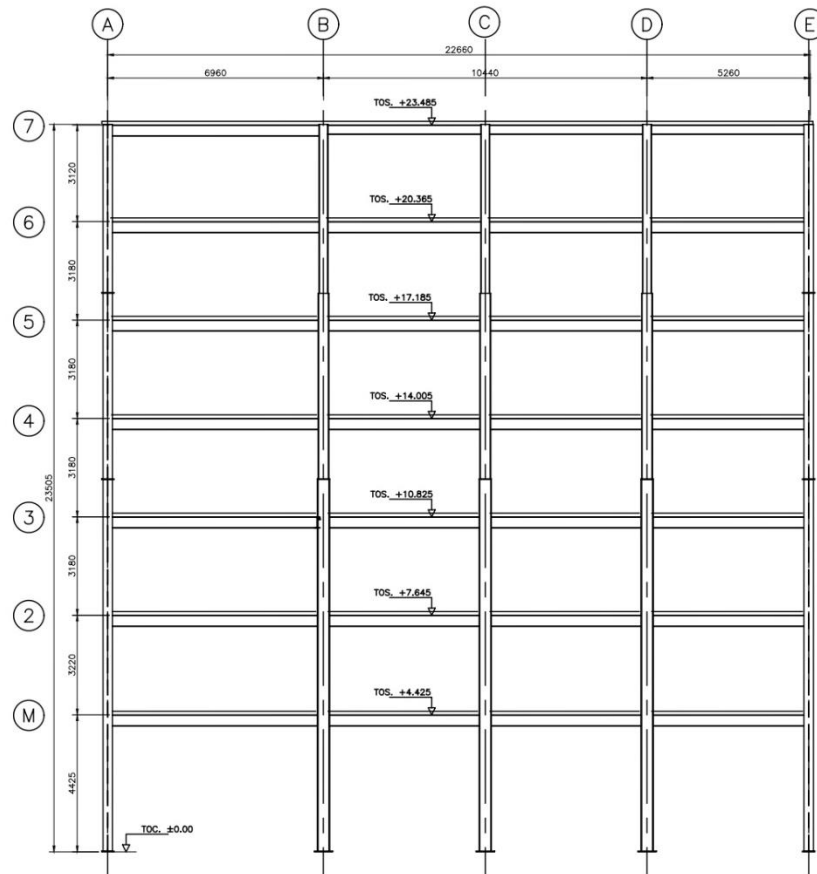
Vista en elevación pórtico tipo 1 (medidas en mm.)
